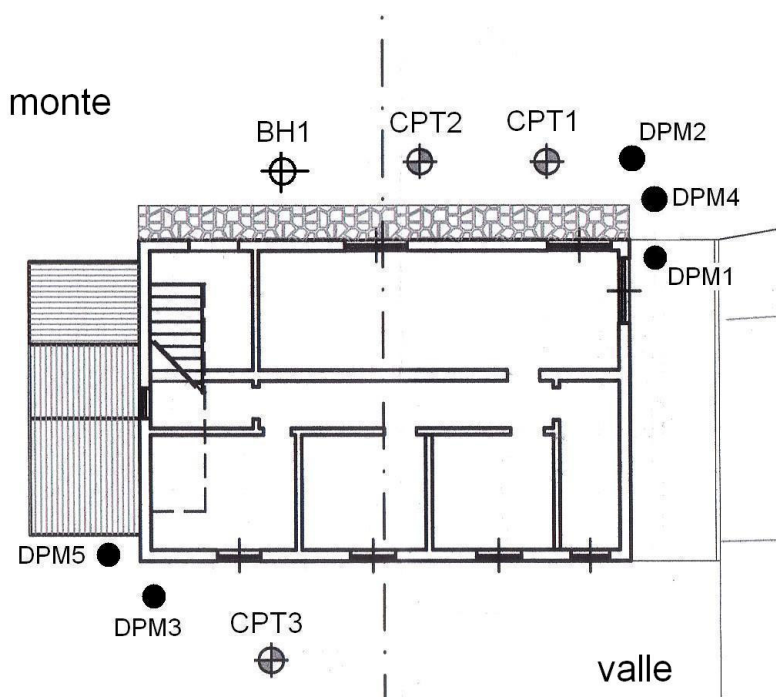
Planimetria dell'edificio ed ubicazione prove in situ
